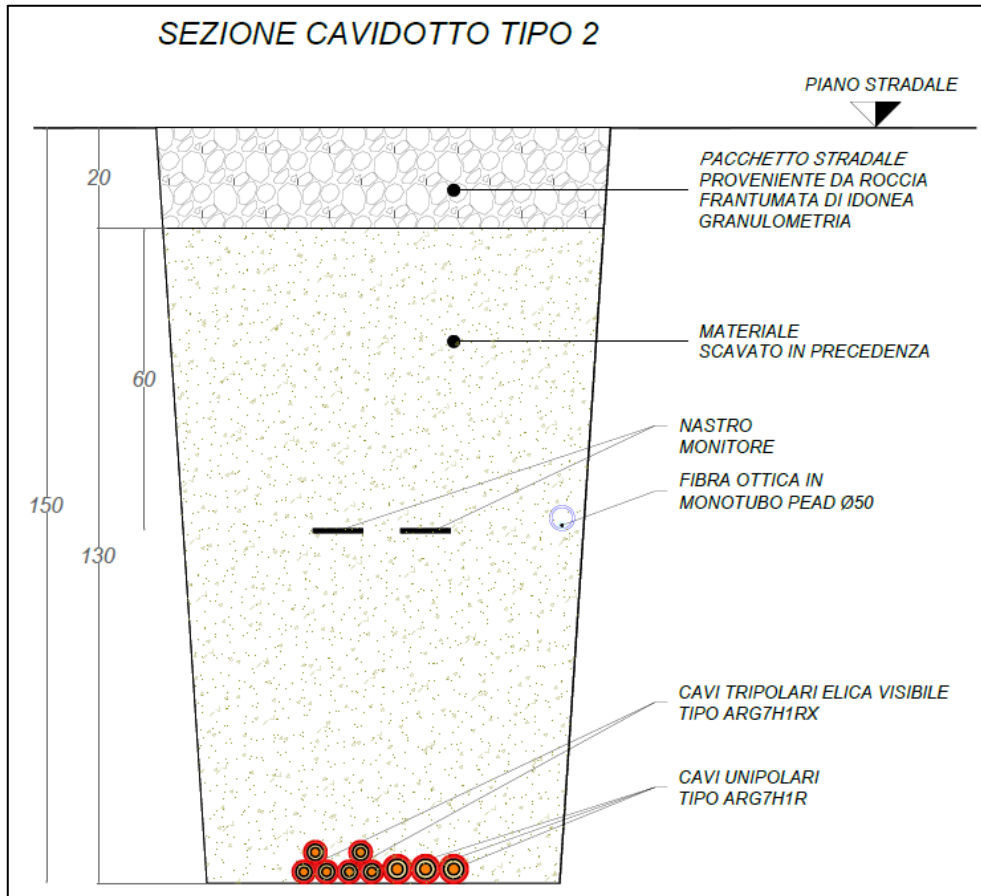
Sezione di posa cavidotto MT a 30 kV – tipo 2
